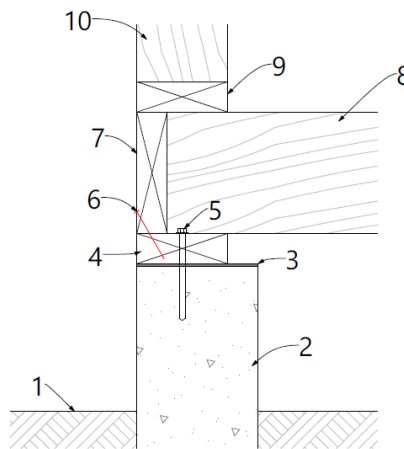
Вузол примикання підкладкова дошка – балка перекриття – стійка каркасу стіни: 1 – поверхня ґрунту; 2 – фундамент; 3 – 2 шари руберойду; 4 – підкладкова дошка; 5 – анкерний болт; 6 – цвях; 7 – обв'язувальна дошка; 8 – балка перекриття; 9 – нижня обв'язка каркасної стіни; 10 – стійка каркасу стіни
